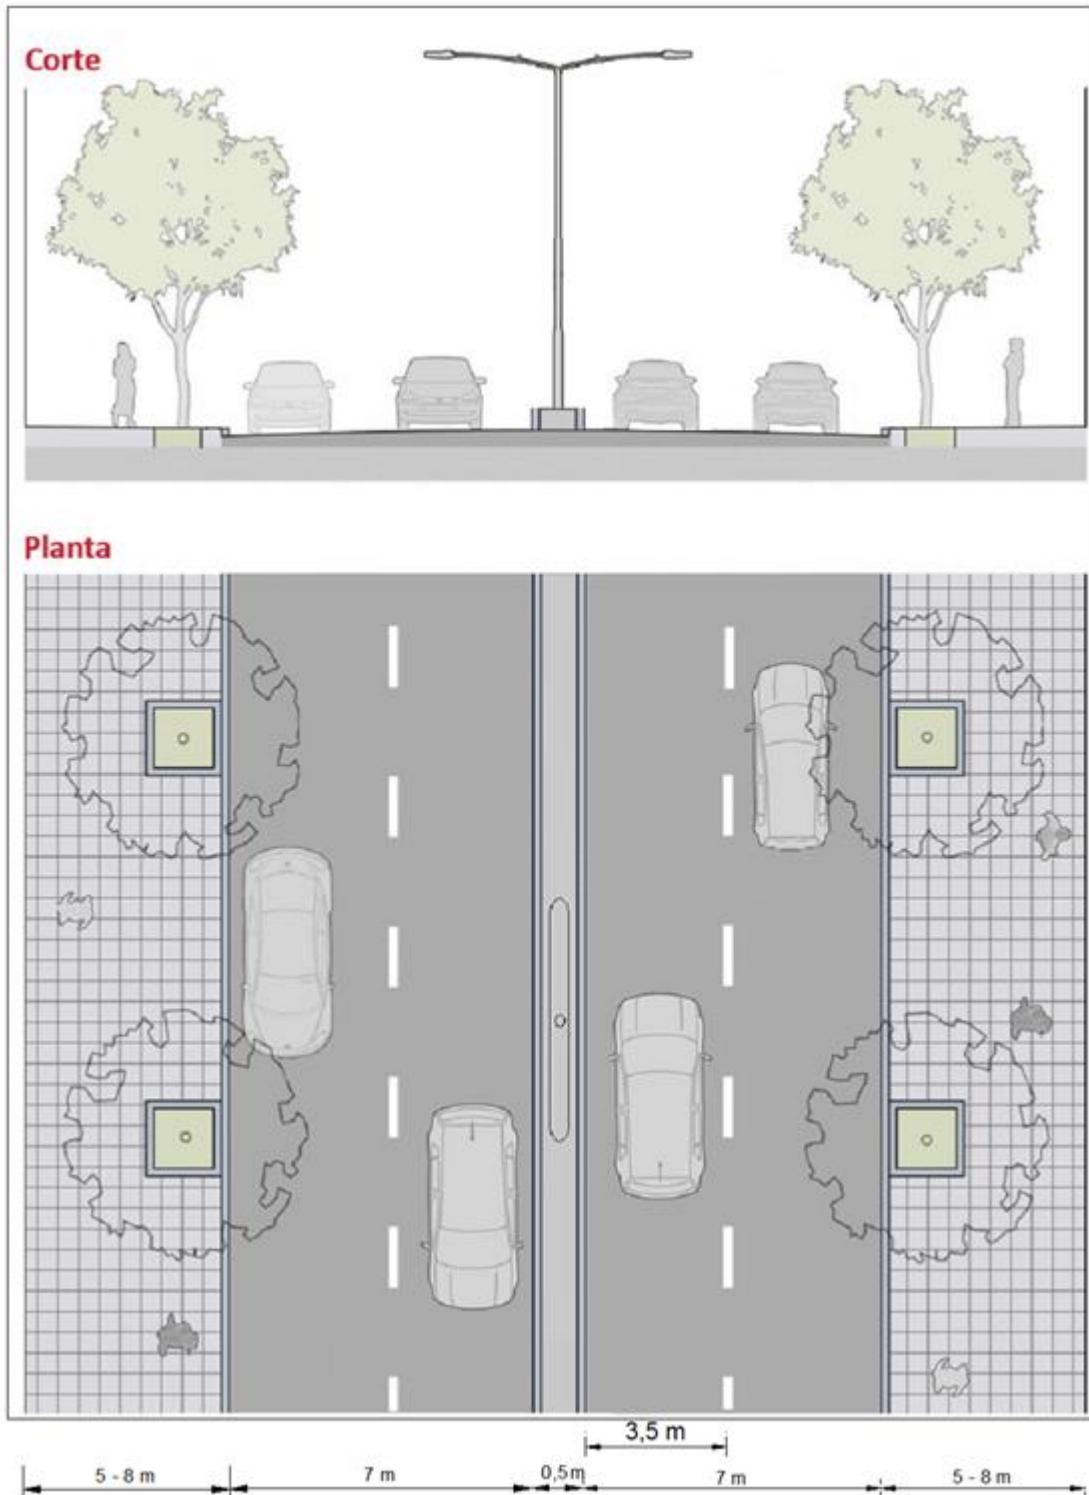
Esquema de planta y corte de av. Castelli en el tramo de estudio. Situación actual.
